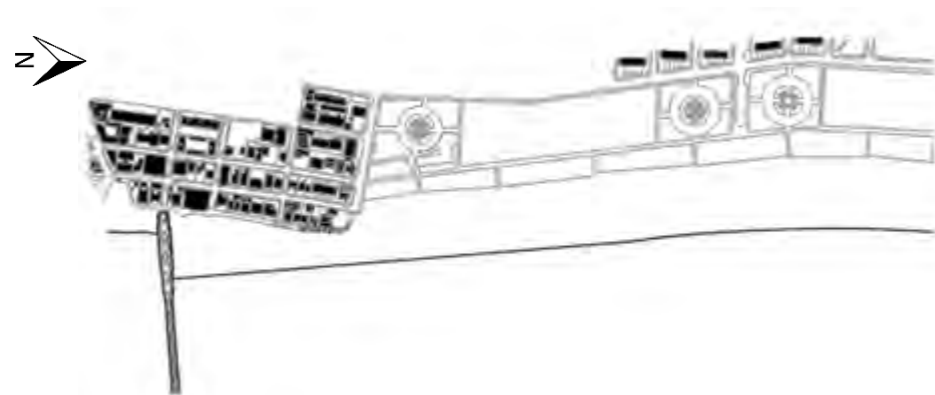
Forma en planta de la alternativa 2: espigón semisumergido, de la playa del Mojón. Fuente: Elaboración propia.
